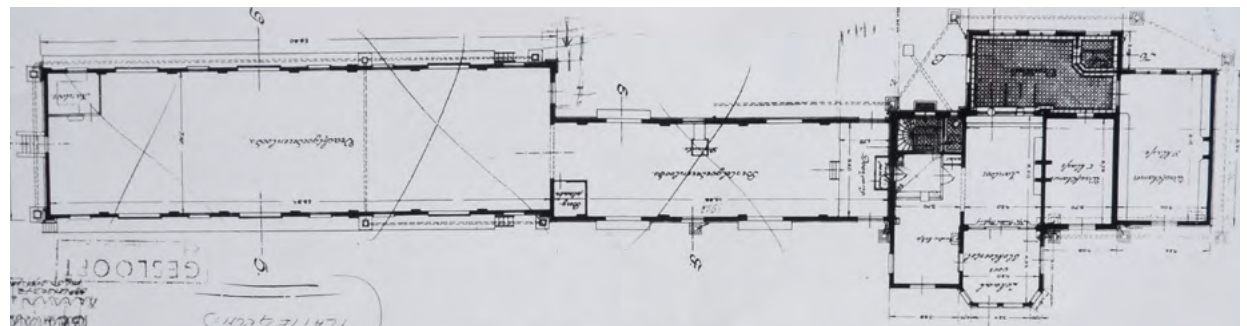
Plattegrond met de locatie van het oude station. Emplacement Doetinchem, Bestekstekening 19, GOLS, steendruk zonder datum. Het Utrechts Archief (HUA), archief Nederlandse Spoorwegen, 959, inv nr 8264
